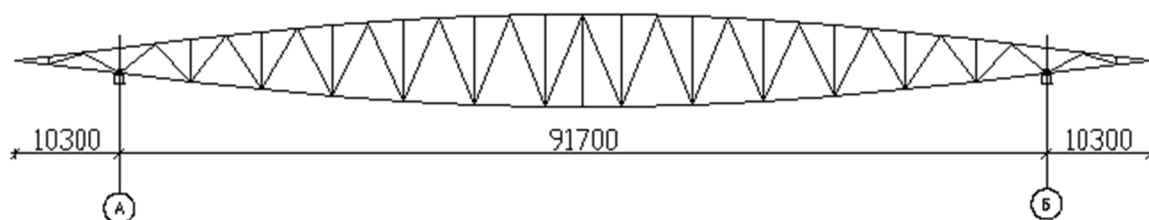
Геометрическая схема стропильной фермы типа «Рыбка»
